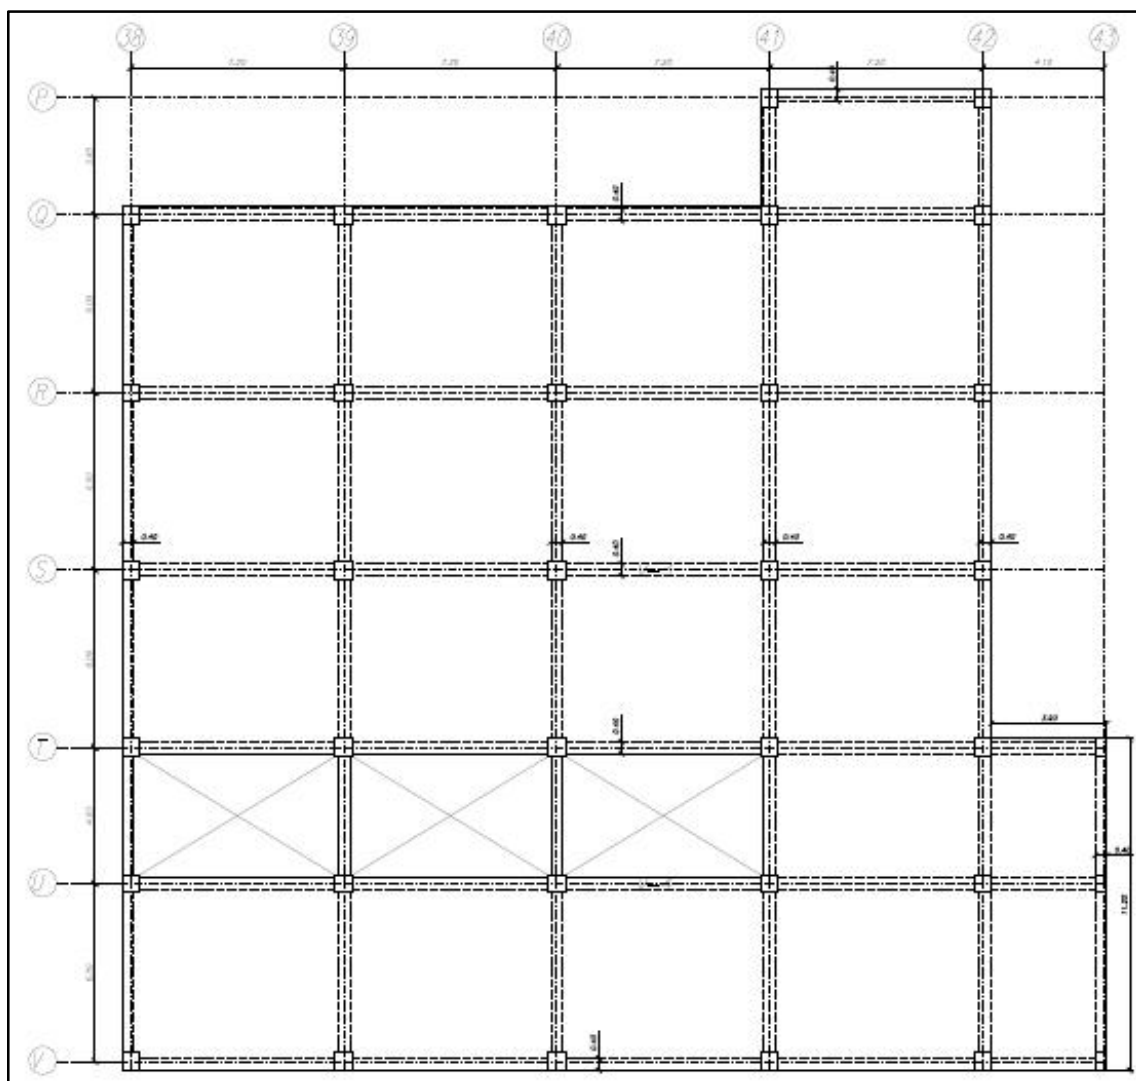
Planta estructural N+11.88, Consulta Externa I
